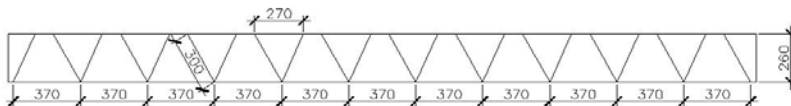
Типовая схема элемента перекрытия (фермы).
